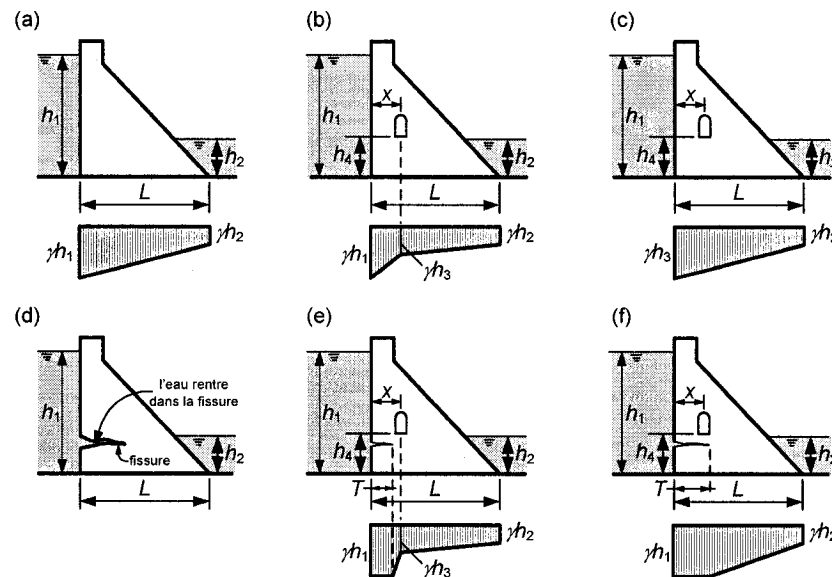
Conditions de sous-pressions à considérer: (a) sans drainage; (b) avec drainage; (c) avec drainage mais $x < 0.05h_1$; (d) fissuration et modifications de sous-pressions; (e) section fissurée, avec drainage et $T < x$; (f) section fissurée, avec drainage et $T > x$ (adaptée de USACE 1995)
